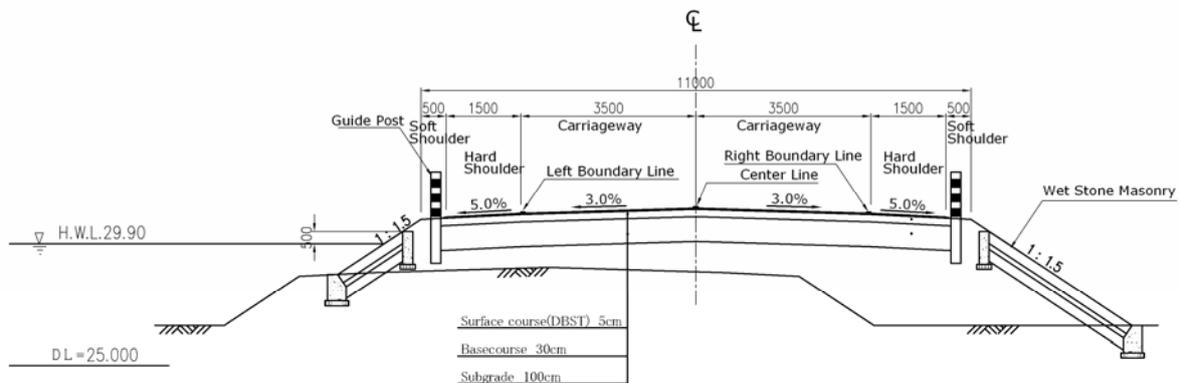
フェニエ橋取付道路標準断面図
